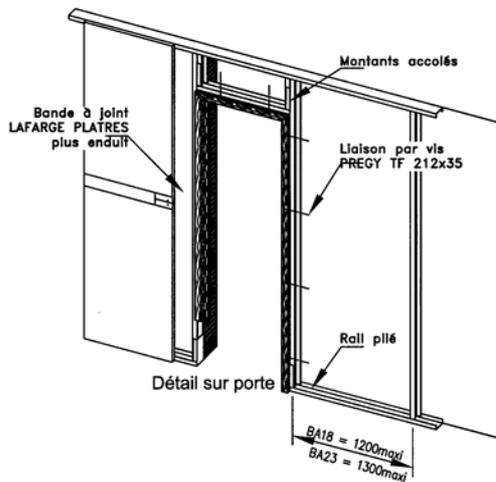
Doublage sur ossature verticale et plaques horizontales BA18 et BA23
